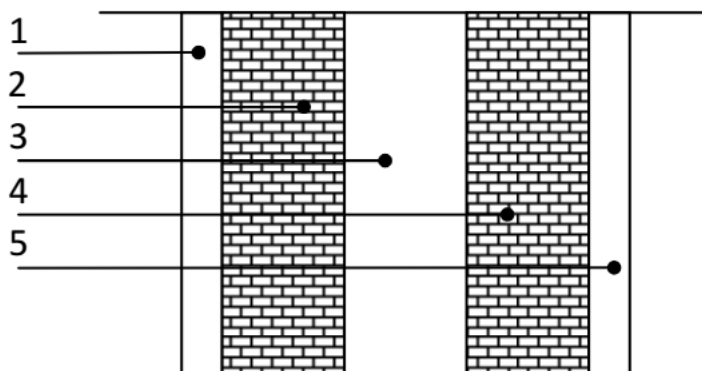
Coupe d'un mur extérieur (en double cloisons). [6]
